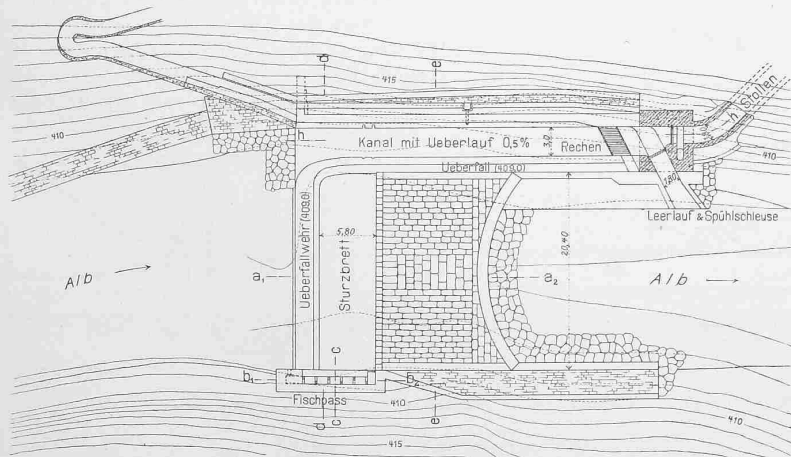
Grundriss der Wehranlage. — Masstab 1:700.
